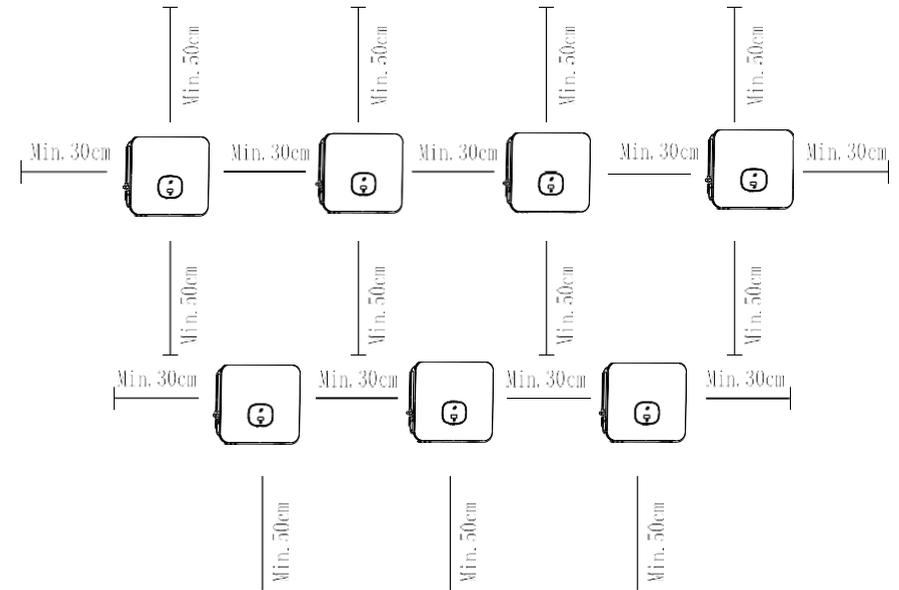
Installationsdimensionen mehrerer Wechselrichter
